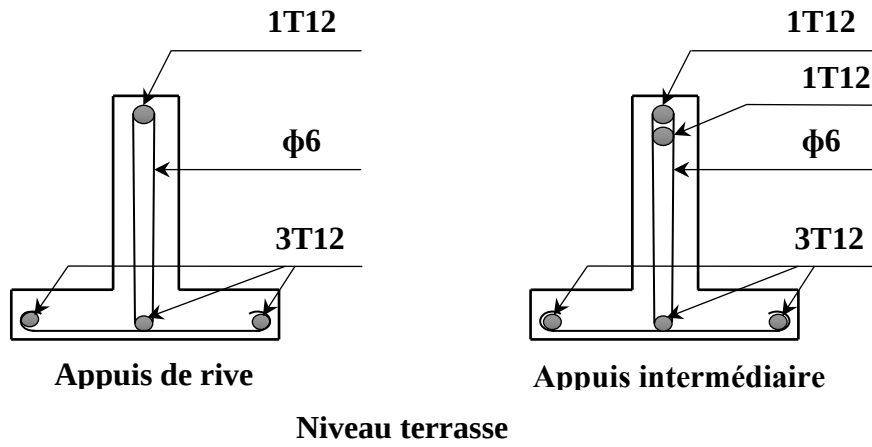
Dessin de ferrailage des poutrelles de niveau terrasse.
